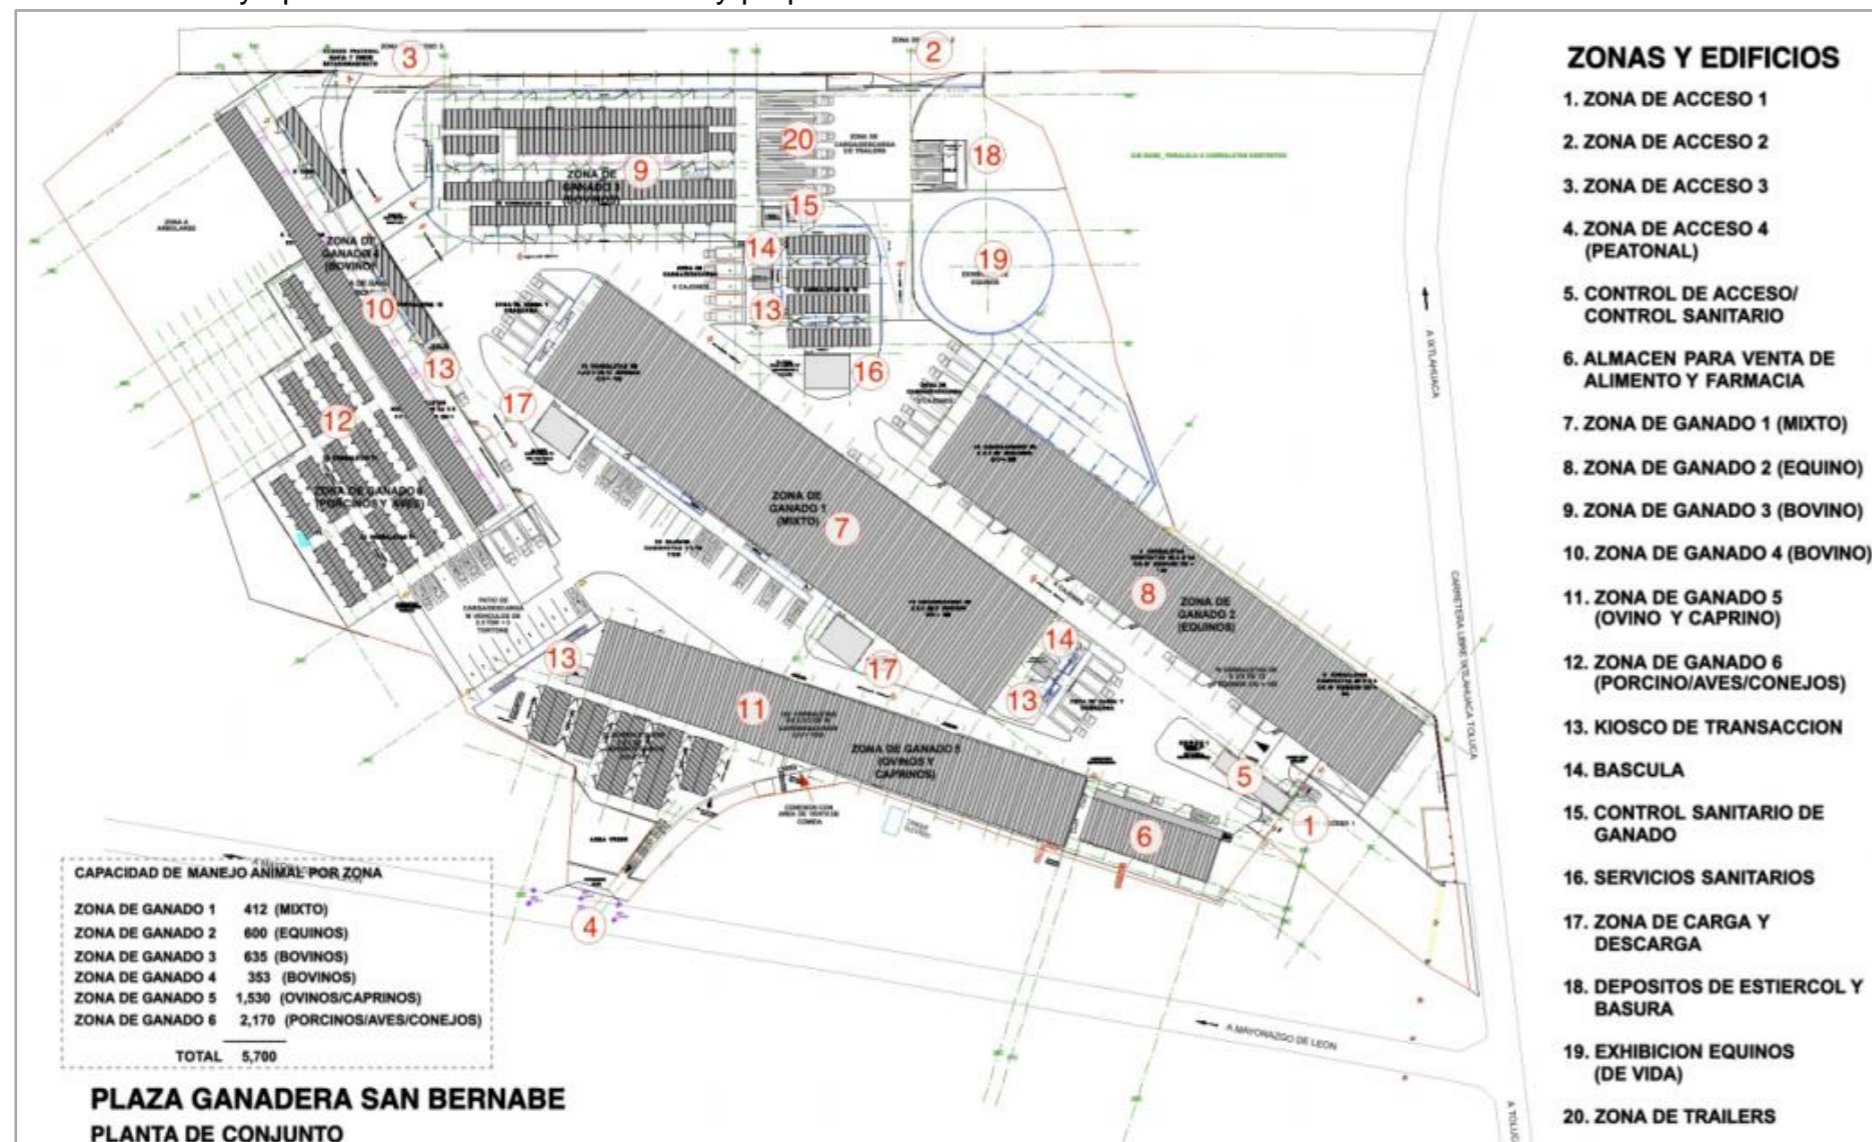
Planta de conjunto Plaza Ganadera San Bernabé. JVAL Arquitectos (2017).
